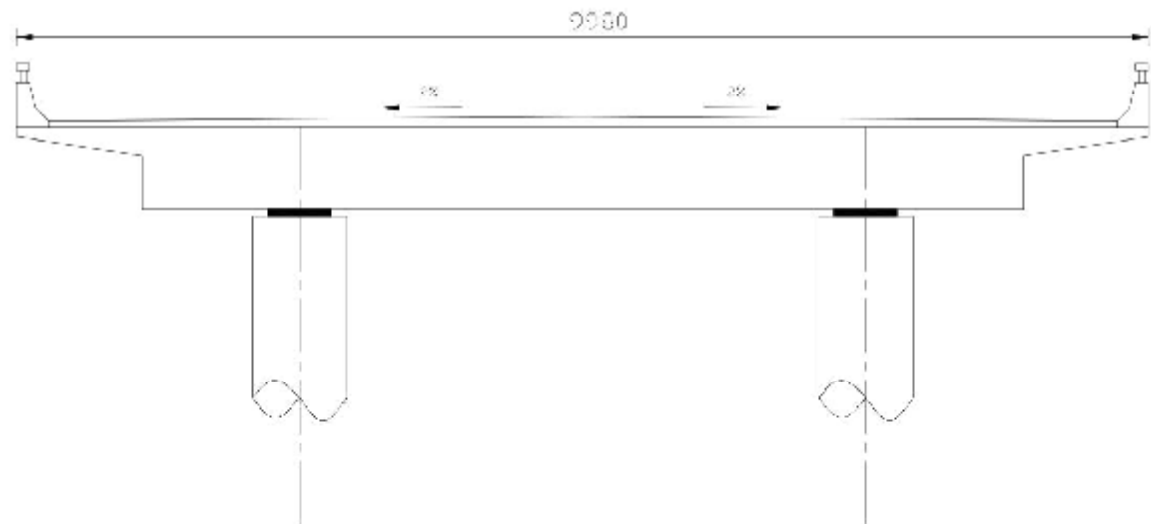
东环 DG 桥梁端截面示意图 (单位: mm)
